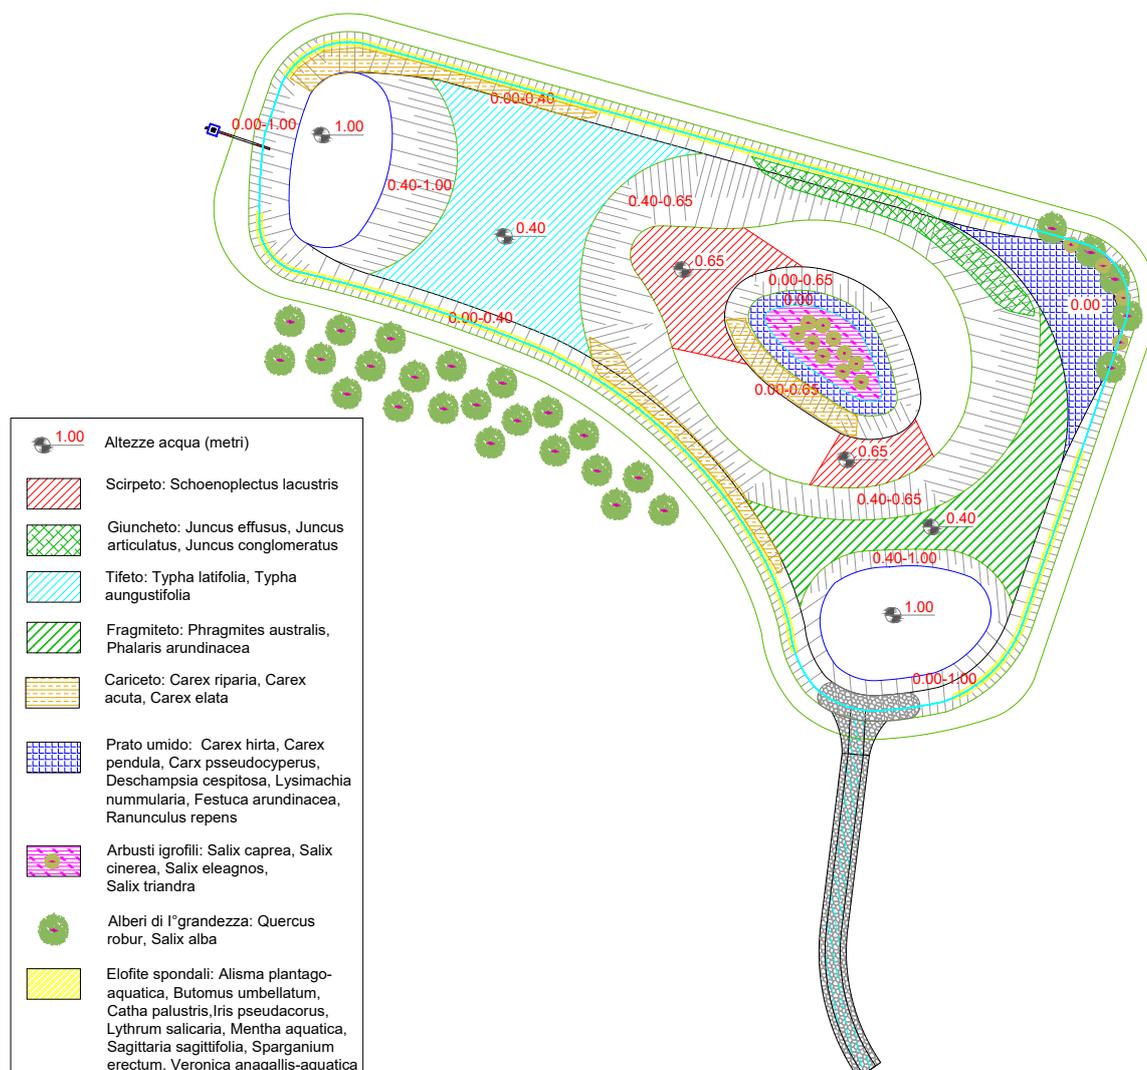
Planimetria della zona umida presente all'interno della cassa di espansione
